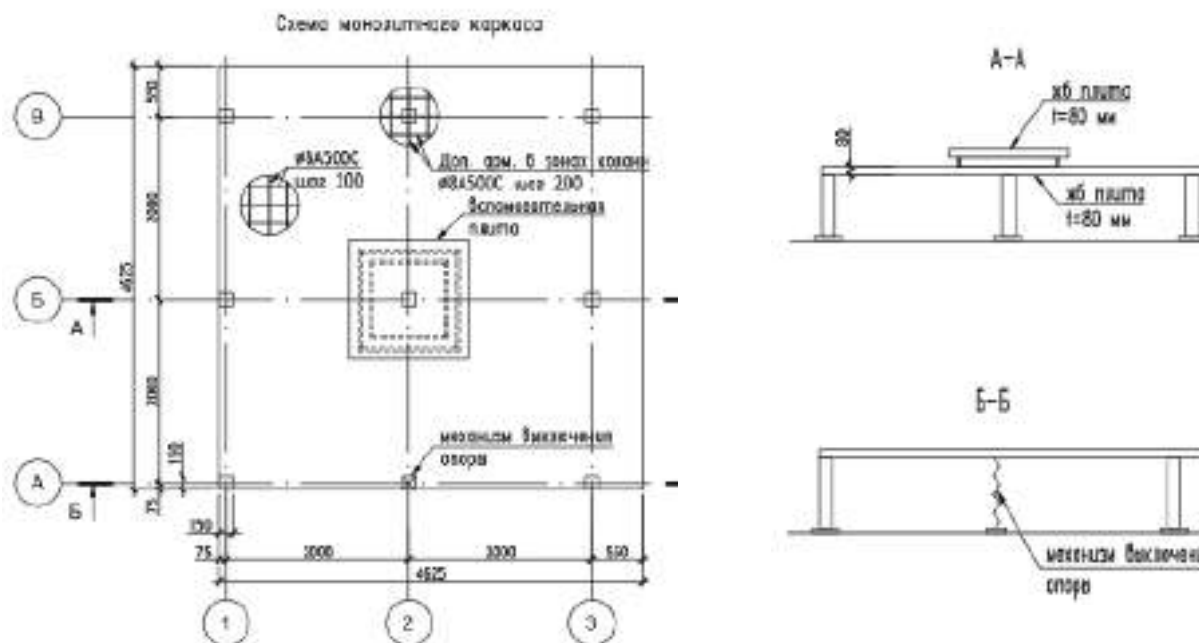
Схема экспериментального фрагмента монолитного каркаса с безбалочным перекрытием
